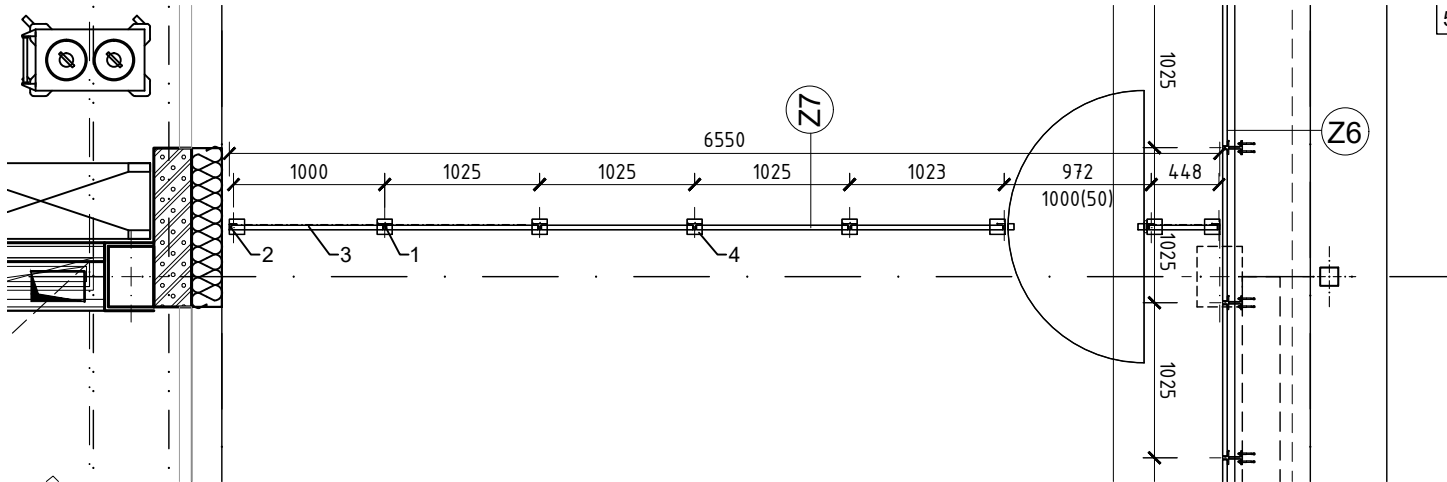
UKOTVENIA POROROŠTU DO ZVÁRANÉHO T-PROFILU
